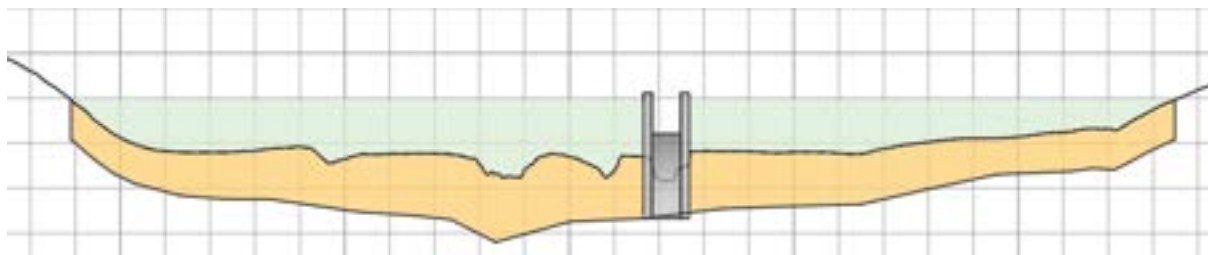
Sección longitudinal de la presa del Arroyo del Sauce
